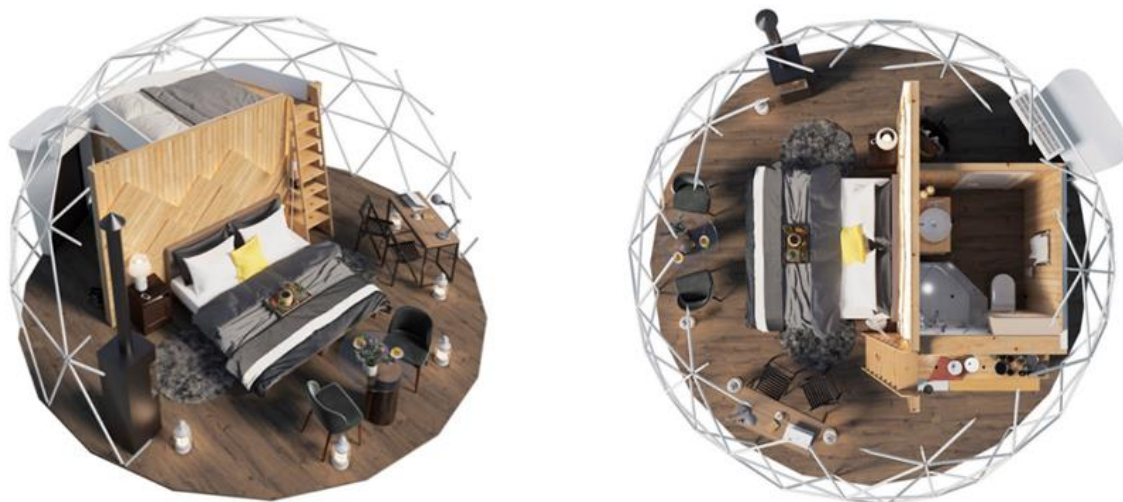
Модуль глэмпинга: общий вид и вид сверху
